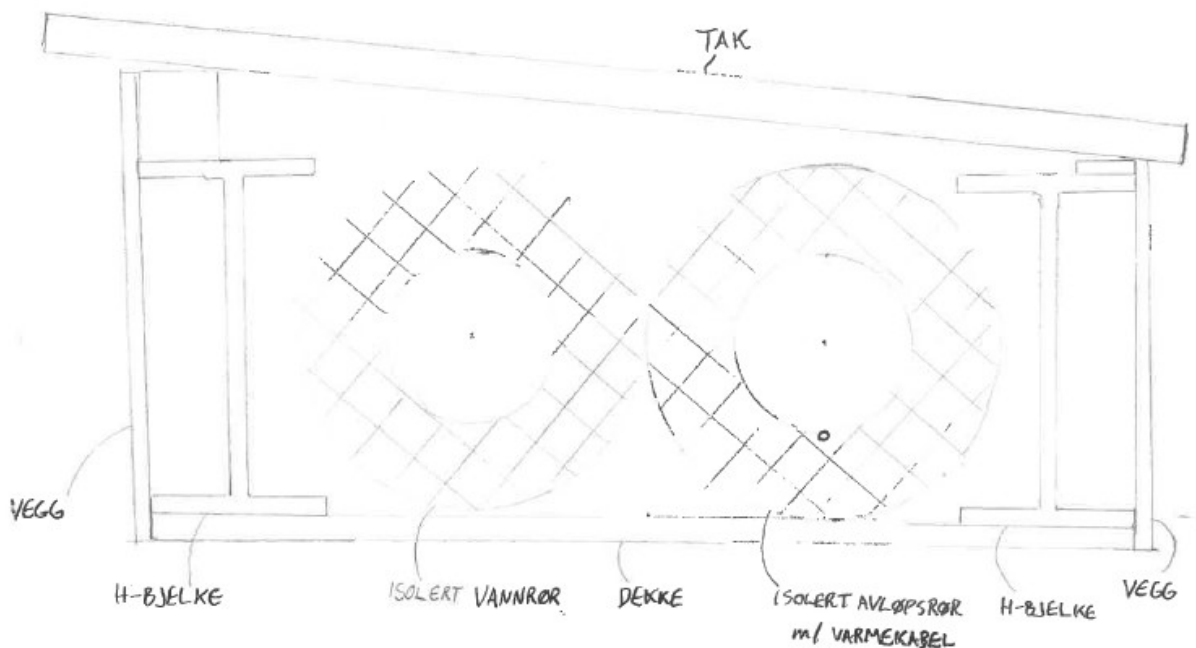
Planlagte VA-ledninger rundt dam Osen
